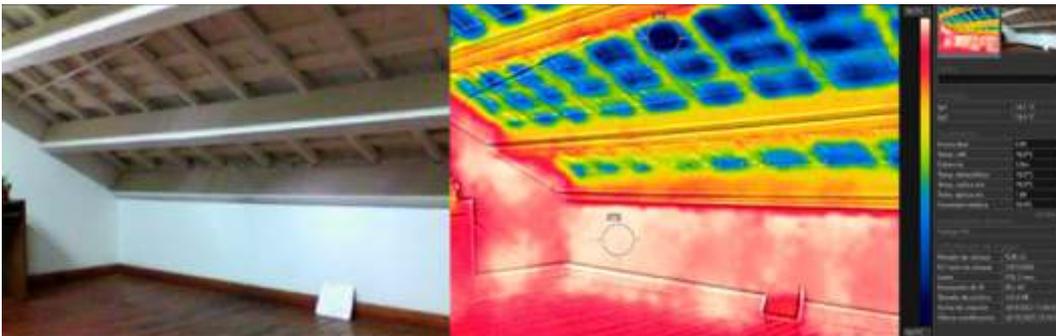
Termografía interior tomada hacia el ángulo nor-oeste de la planta alta.
